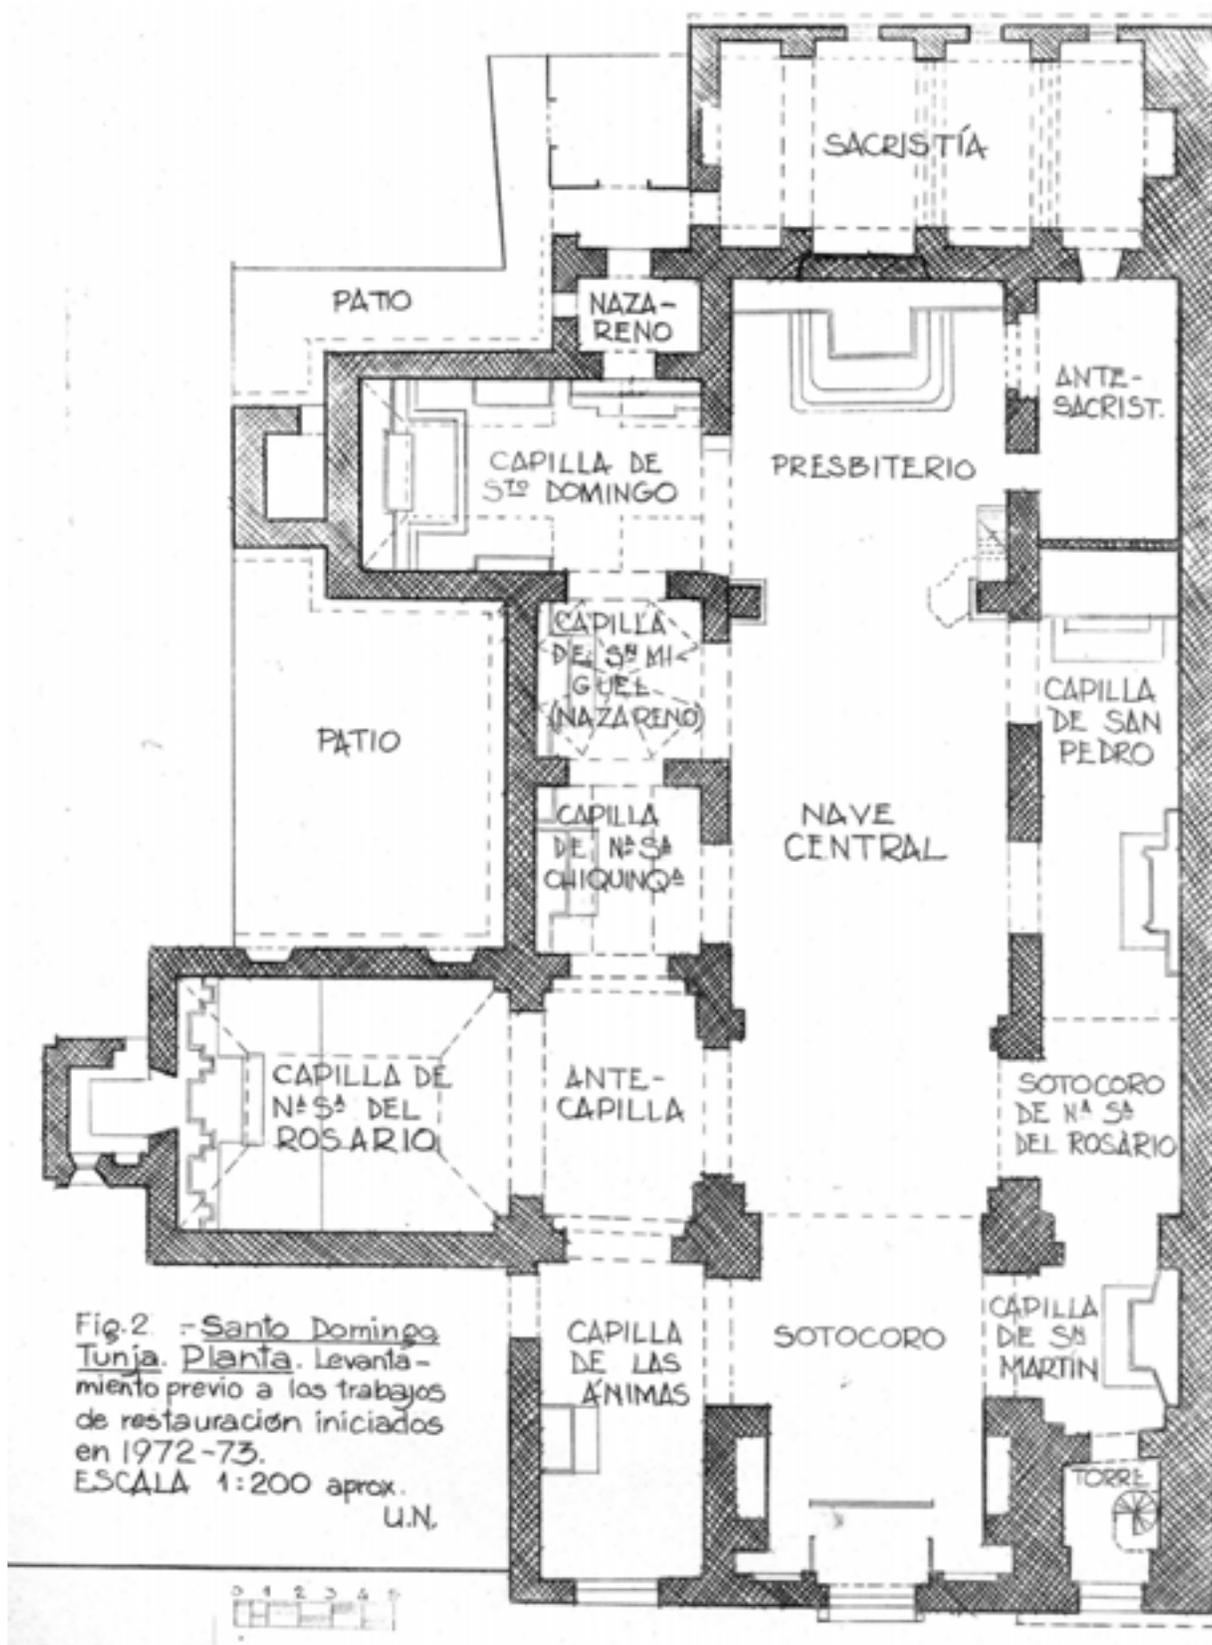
Santo Domingo Tunja. Planta. Levantamiento previo a los trabajos de restauración iniciados en 1972-73. ESCALA 1:200 aprox. U.N.
